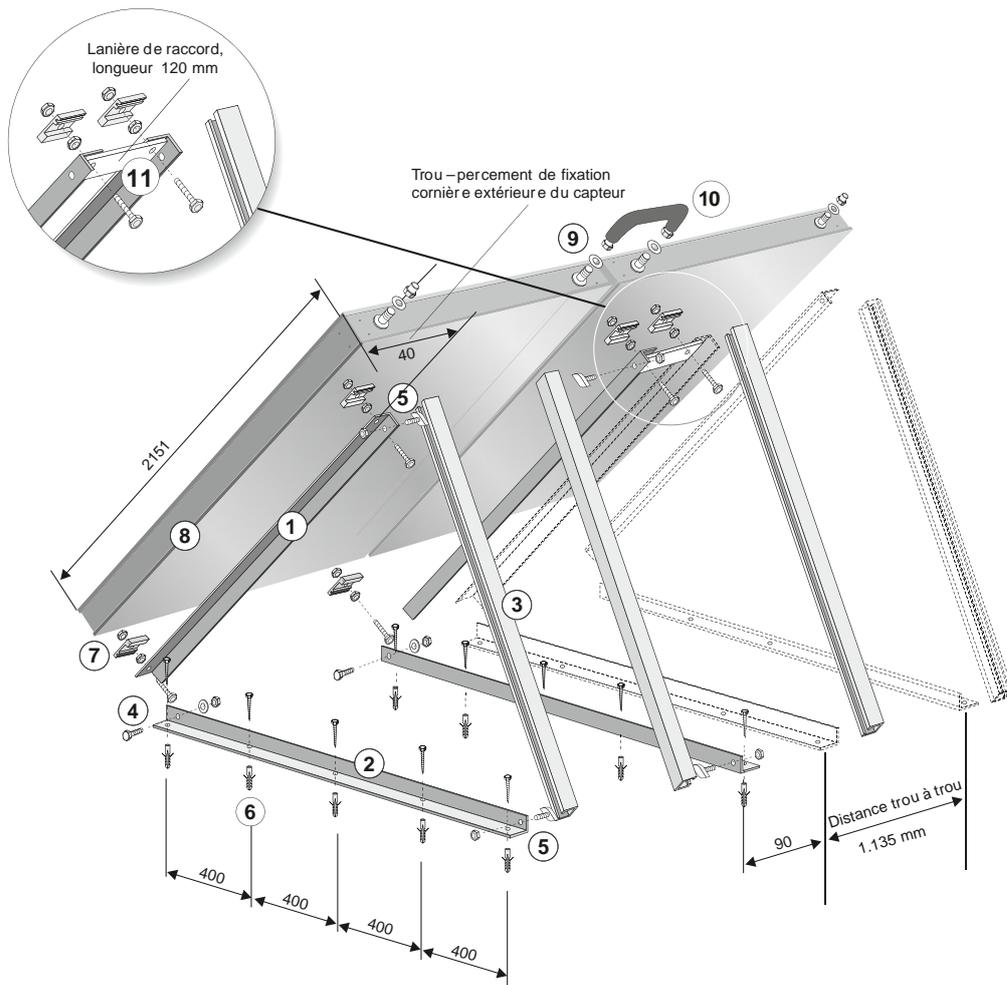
Le kit d'extension pour montage sur châssis avec orientation verticale du capteur HelioPlan N :
